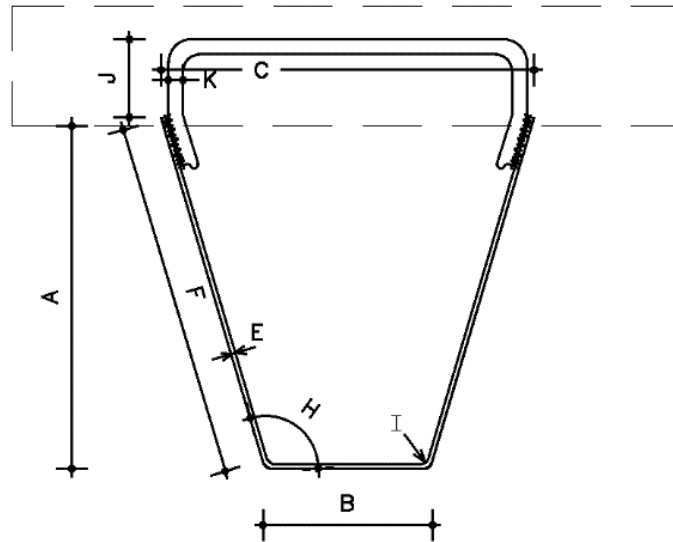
Chapa doblada y perno, $K = \varnothing 10 \text{ mm}$ y $J = 60 \text{ mm}$, soldado a cada lado con una separación de 100 mm
